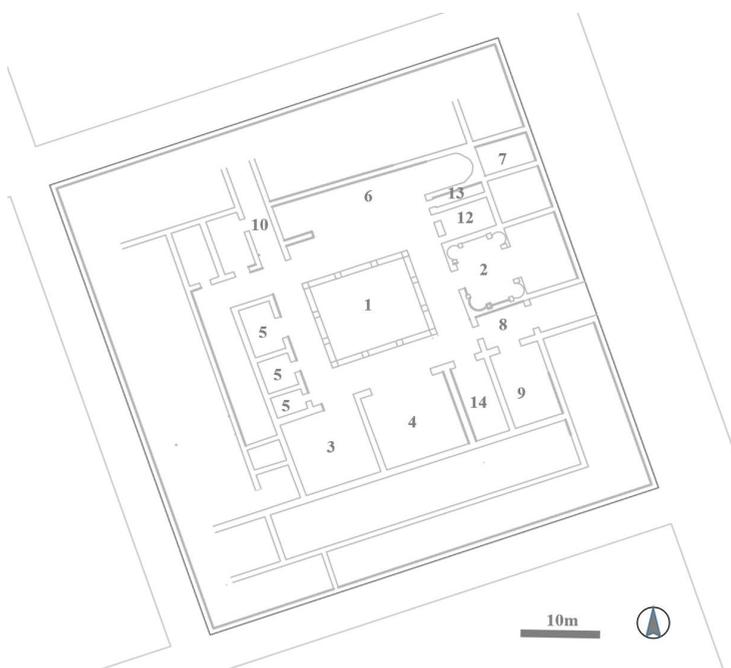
Planta interpretada da fase II da *domus* das Antigas Cavalariças (©UAUM)
